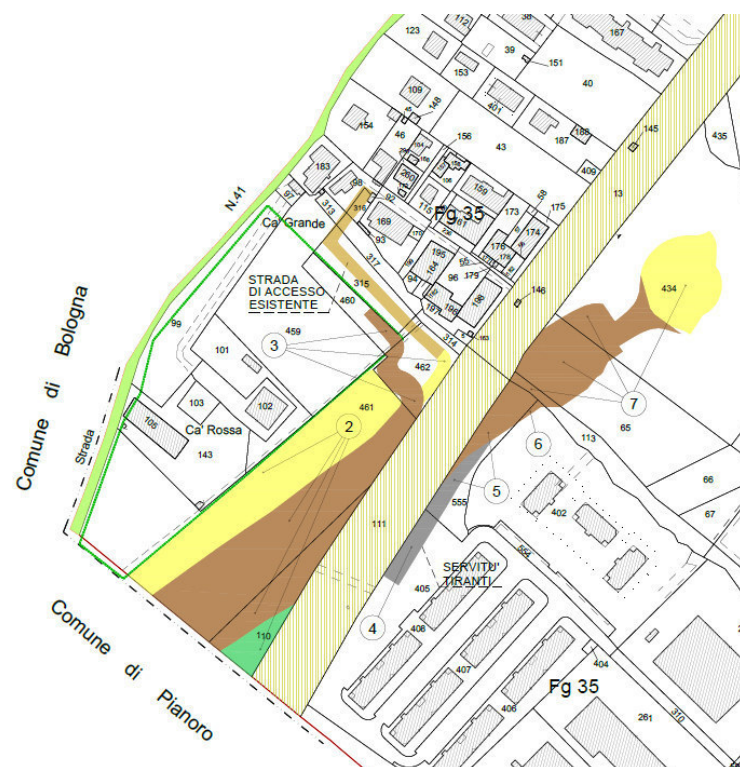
Stralcio planimetrico Espropri San Lazzaro di Savena.
